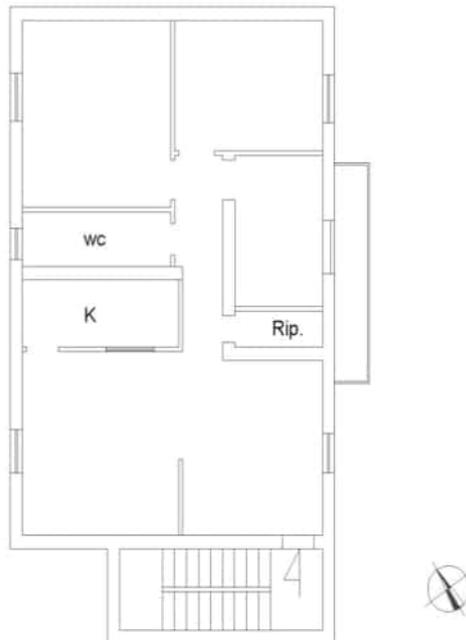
Ultima planimetria catastale in atti [ALL. 4]
